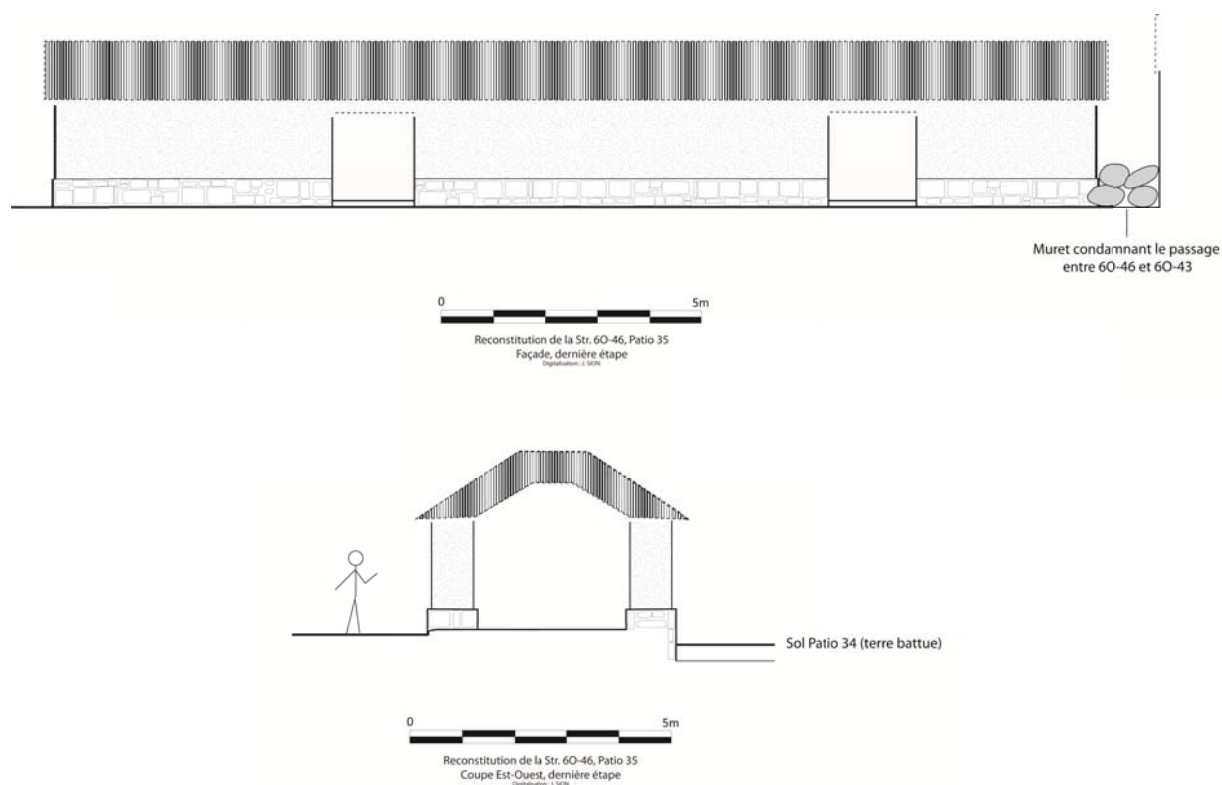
élévation de la façade est et coupe est-ouest de l'Edifice 60-48 (élévations en matériaux périssables) lors de l'Etape 5 datée de la phase Muuch, 830-950 apr. J.C. (modifié de Sion 2014)
